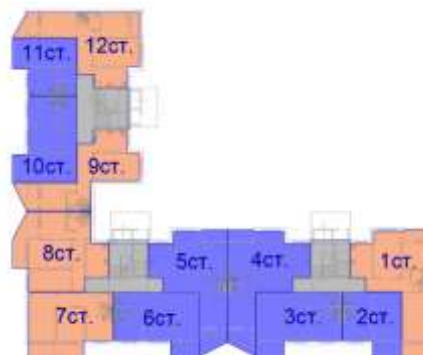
Умовне зображення квартир з суттєвою площею зовнішніх огорожувальних конструкцій на плані будівлі, сірий колір – неопалювальні площі МЗК
